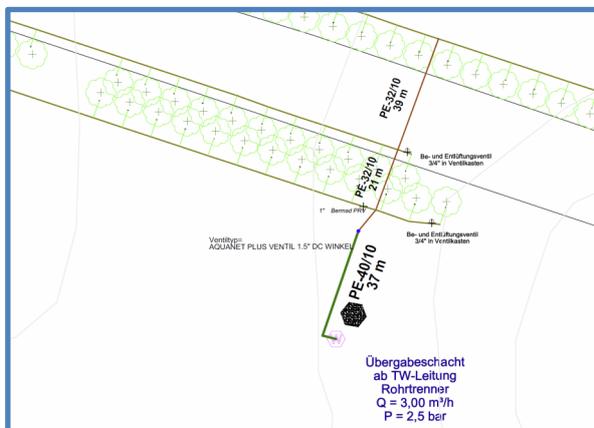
CAD-Plan Baumbewässerung B104(Ausschnitt)
